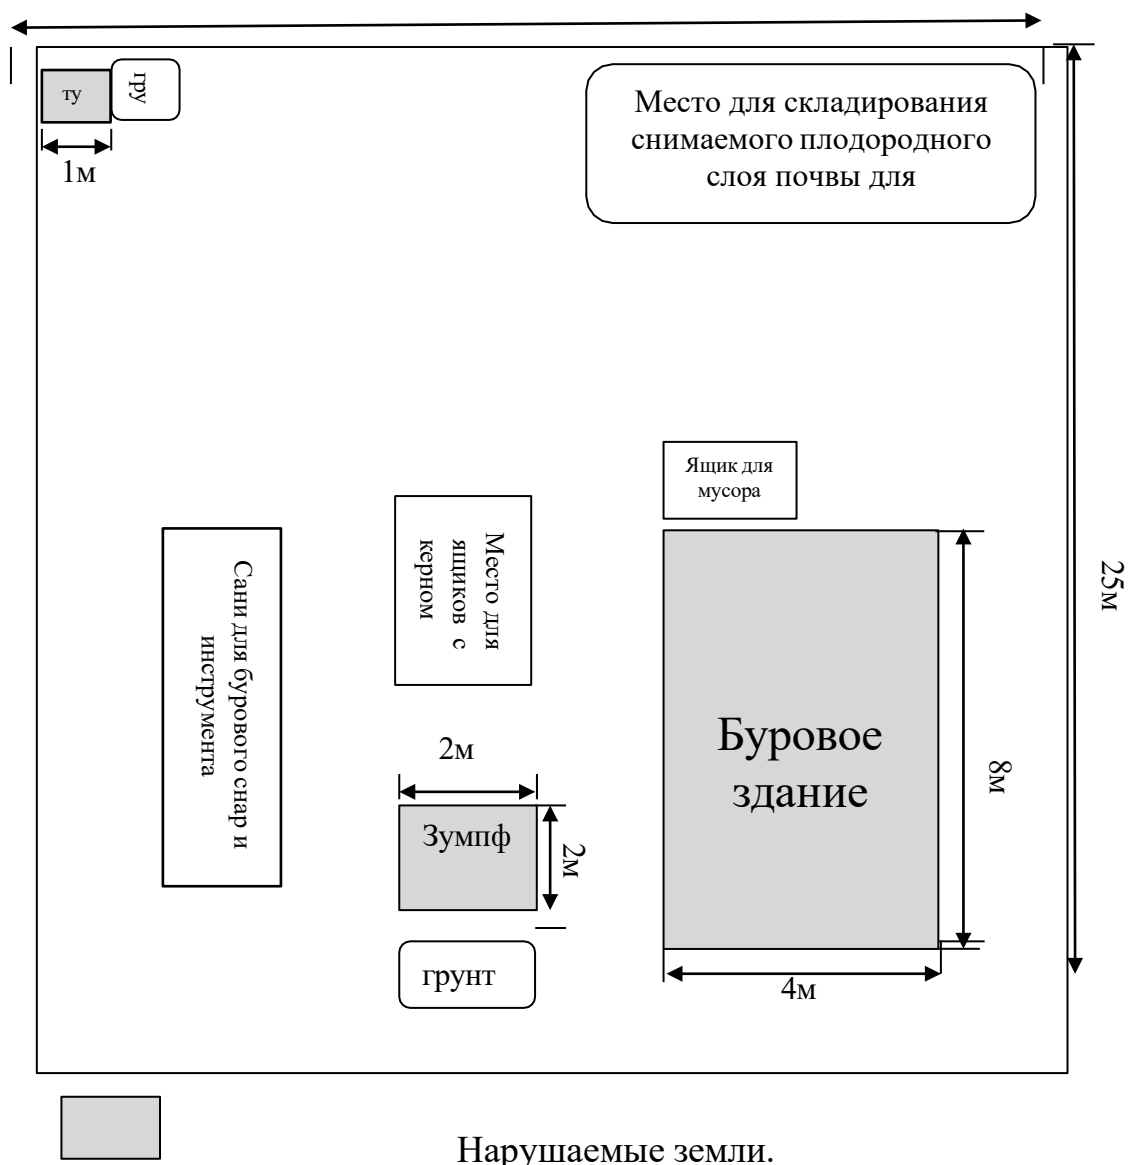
Схема размещения бурового оборудования на площадке
